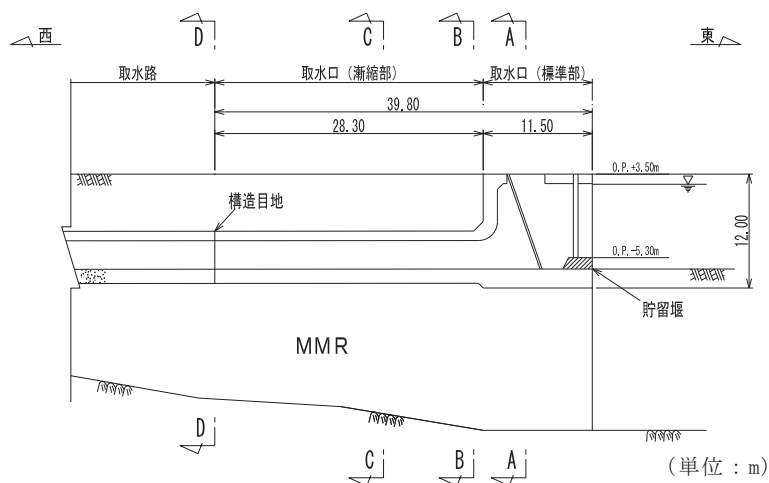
取水口縦断面図 (E-E 断面, 東西)
